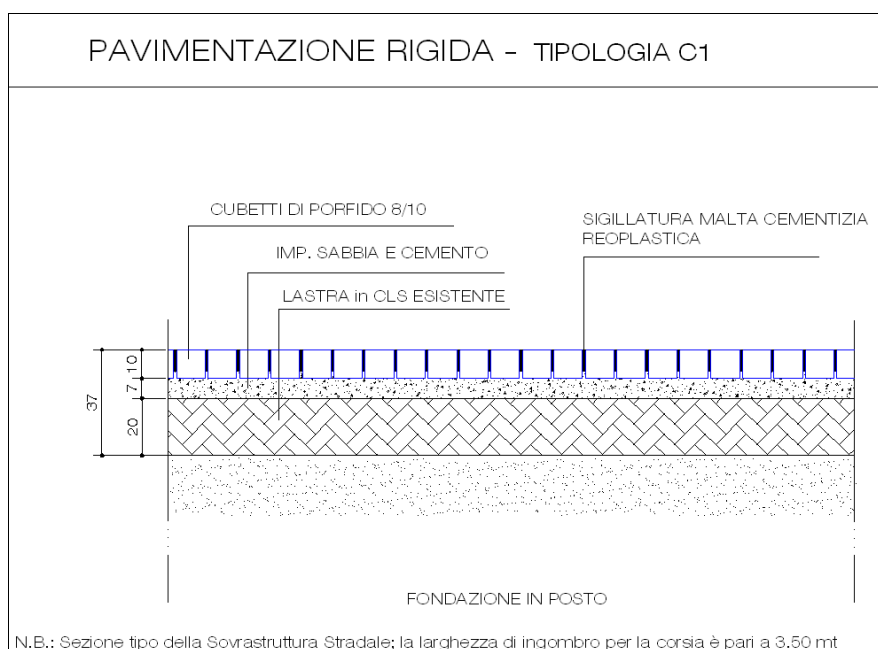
Pacchetto C1 per pavimentazione in pavè con soletta in calcestruzzo
